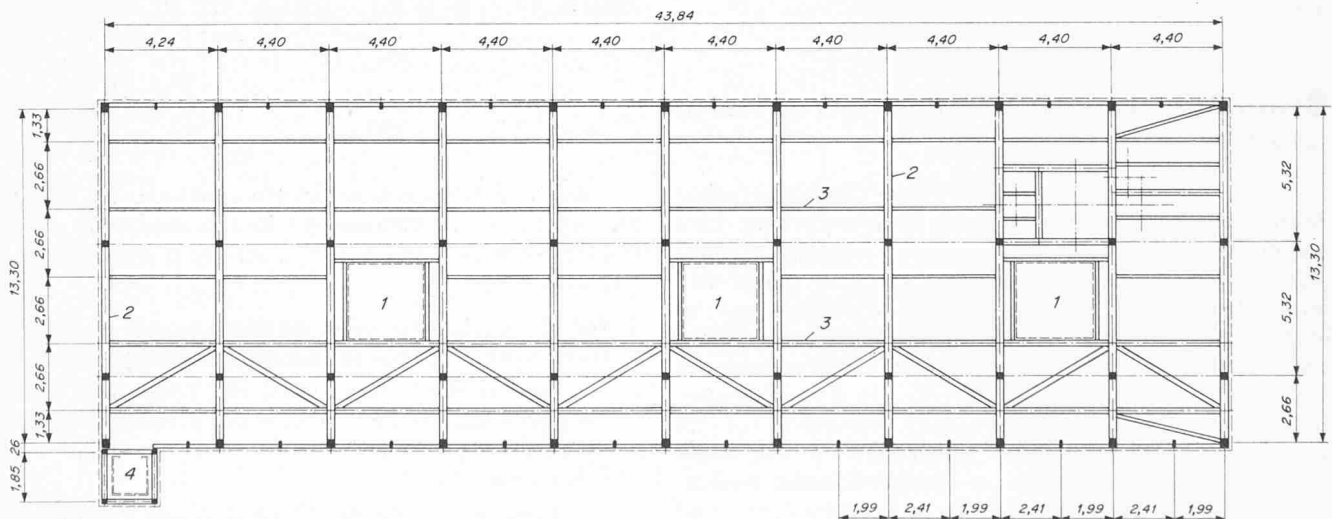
Grundriss 1:300 des Fachwerkes auf Dachhöhe
